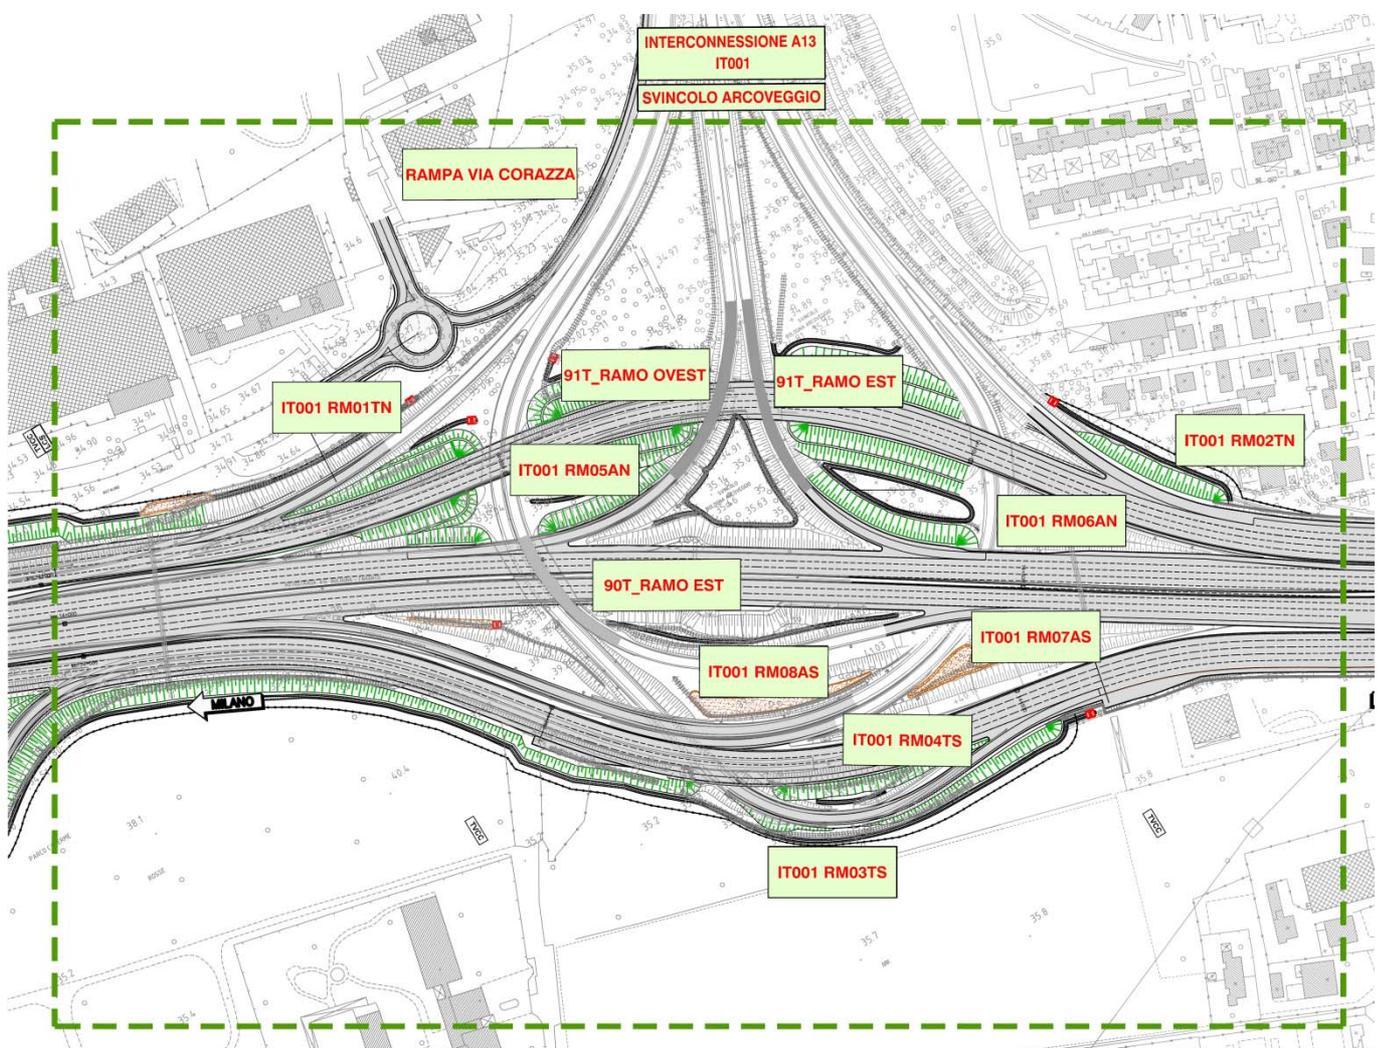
Stralcio planimetrico interconnessione di Arcoveggio
